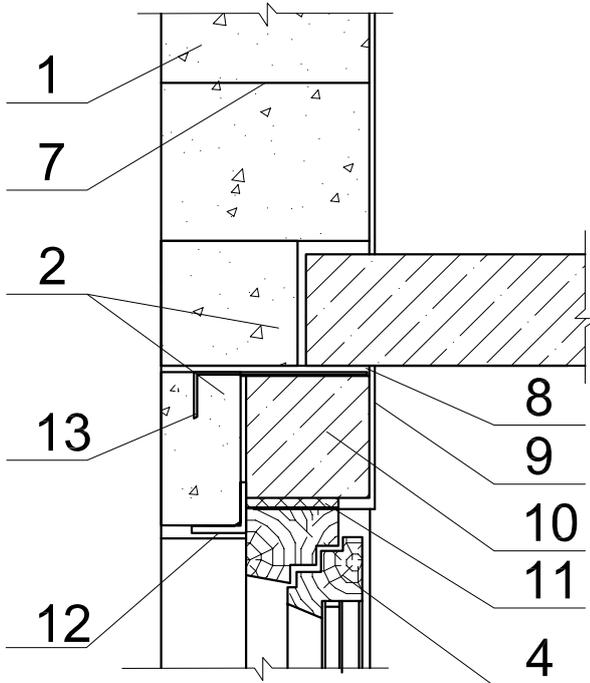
Схема установки анкеров для крепления оконной коробки к газобетонной кладке из блоков ГРАС
